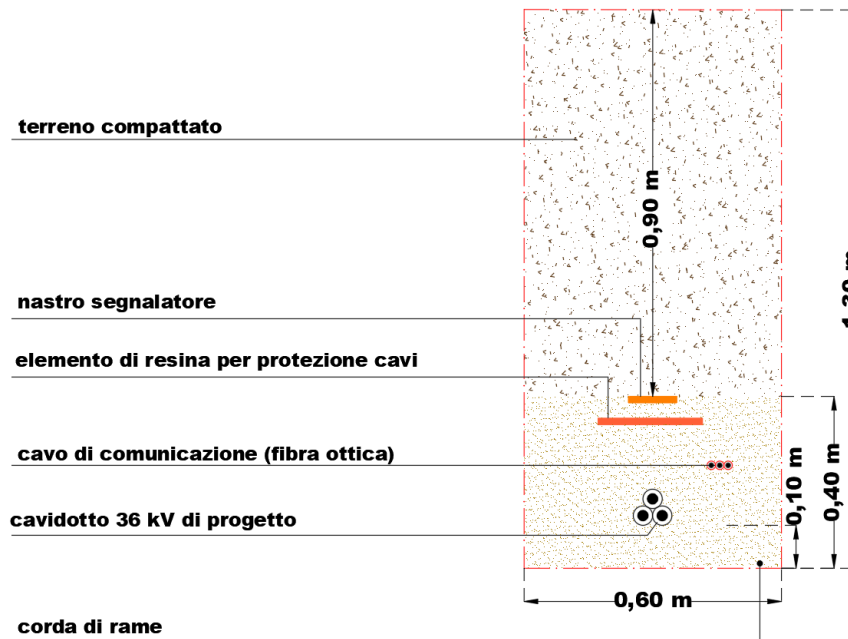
Sezione Cavidotto Singola Terna su Terreno
